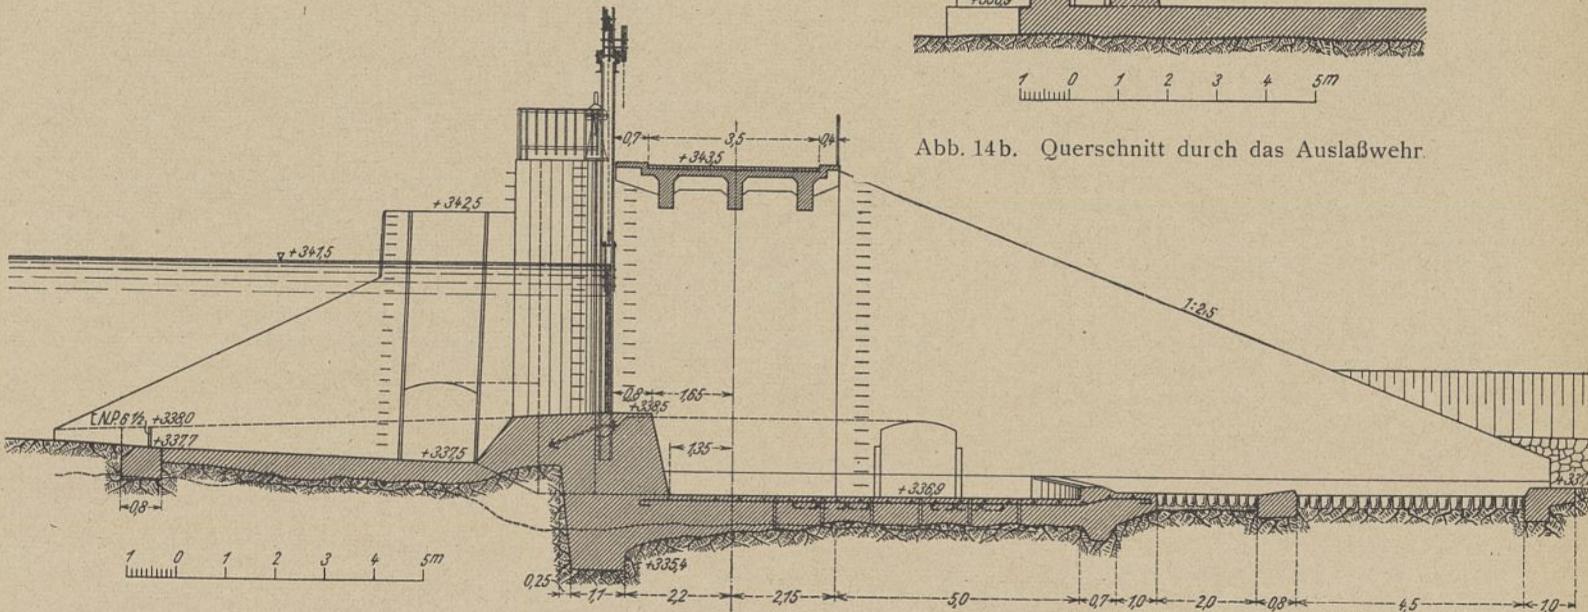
Längsschnitt durch das Auslaßwehr.
